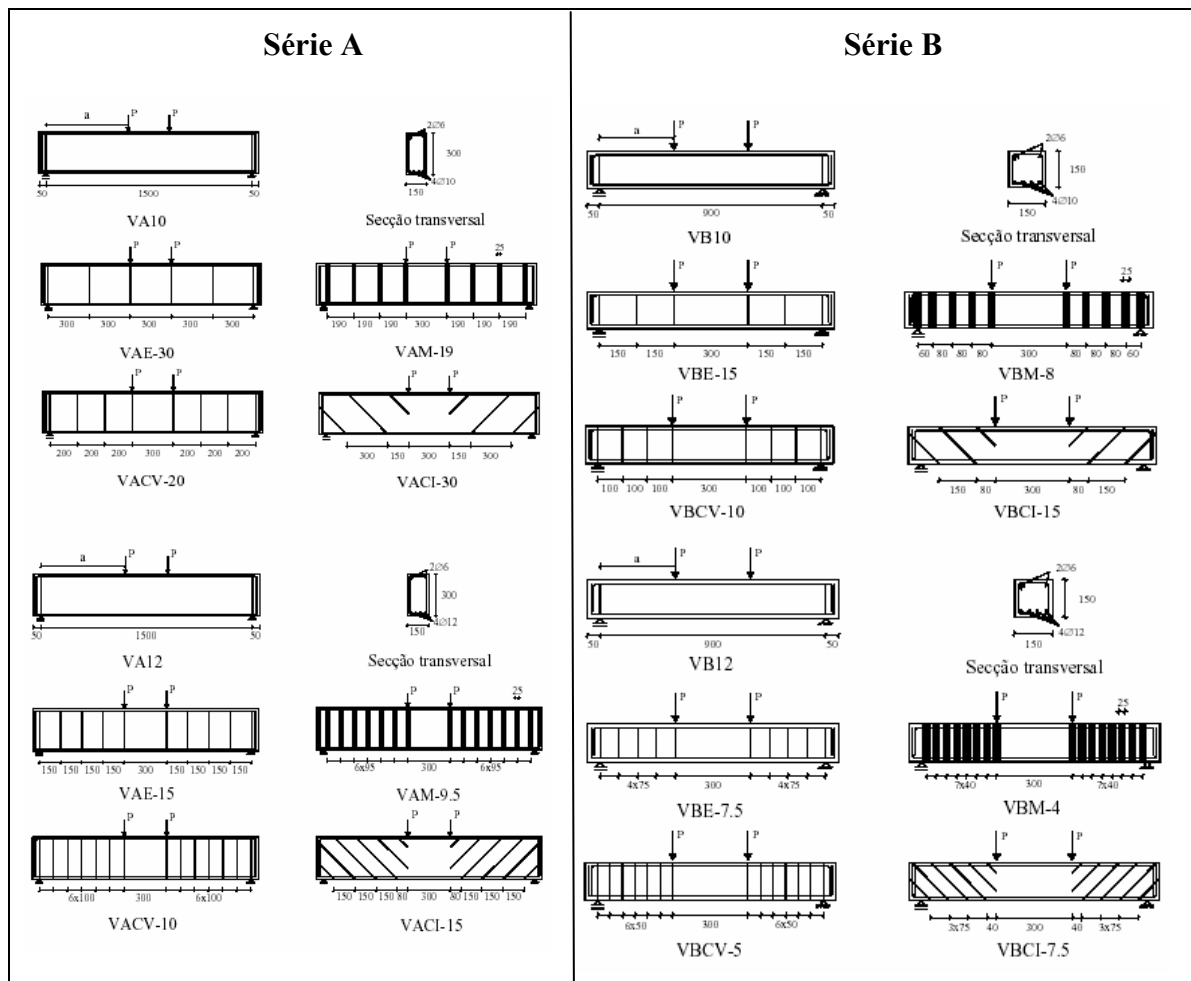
Características das vigas das séries A e B (DIAS, E BARROS 2003).
